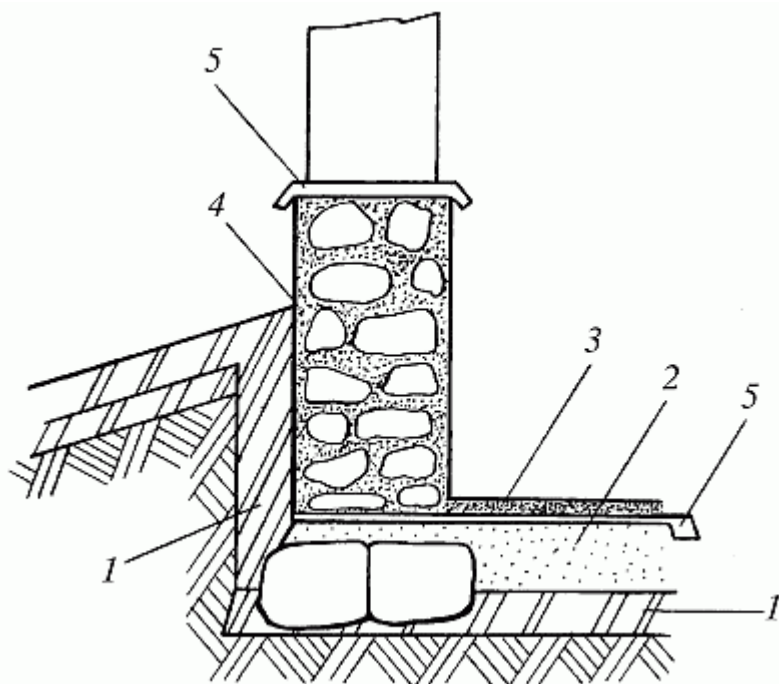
Гидроизоляция стен погреба: 1 – жирная глина; 2 – бетон; 3 – пол из цемента; 4 – цементная штукатурка, покрытая слоем битума; 5 – гидроизоляционный слой
